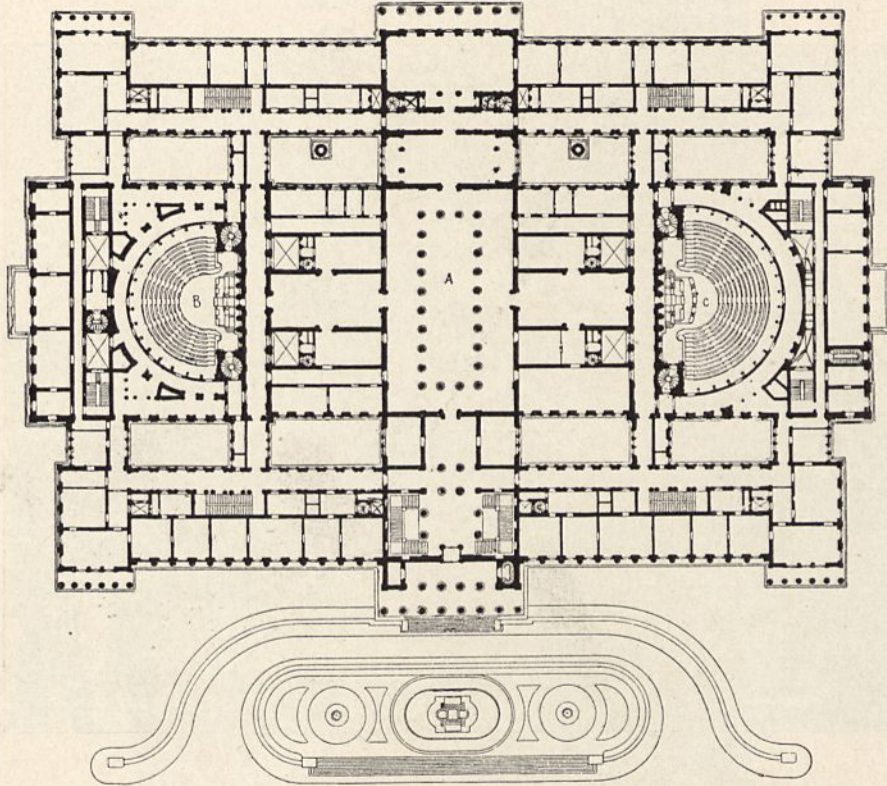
Parlamentsgebäude in Wien. Grundriß des Hauptgeschosses.
